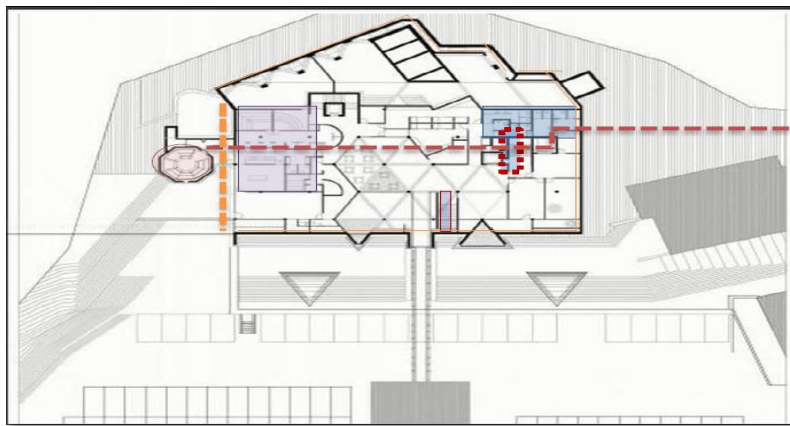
vue sur le plan du RDC, source : Pinterest site.
